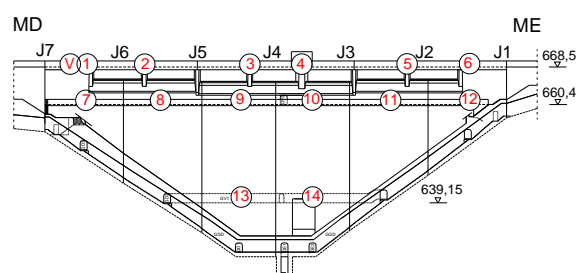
Plano de colocação da aparelhagem utilizada durante o ensaio de vibração forçada
